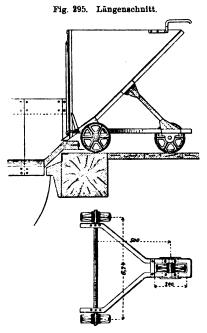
Horizontalabschnitt. Beton-Wagen.
